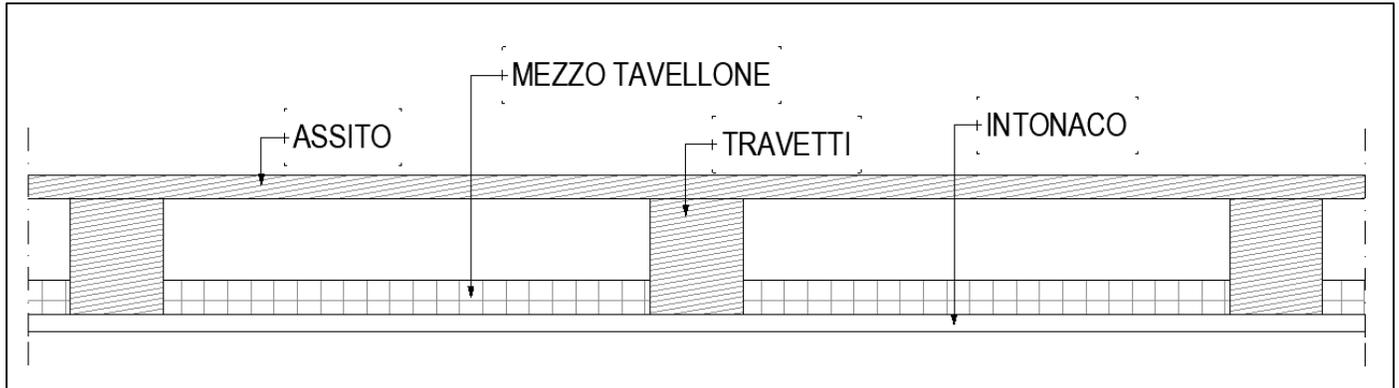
Tipologia di solaio esistente al piano sottotetto
